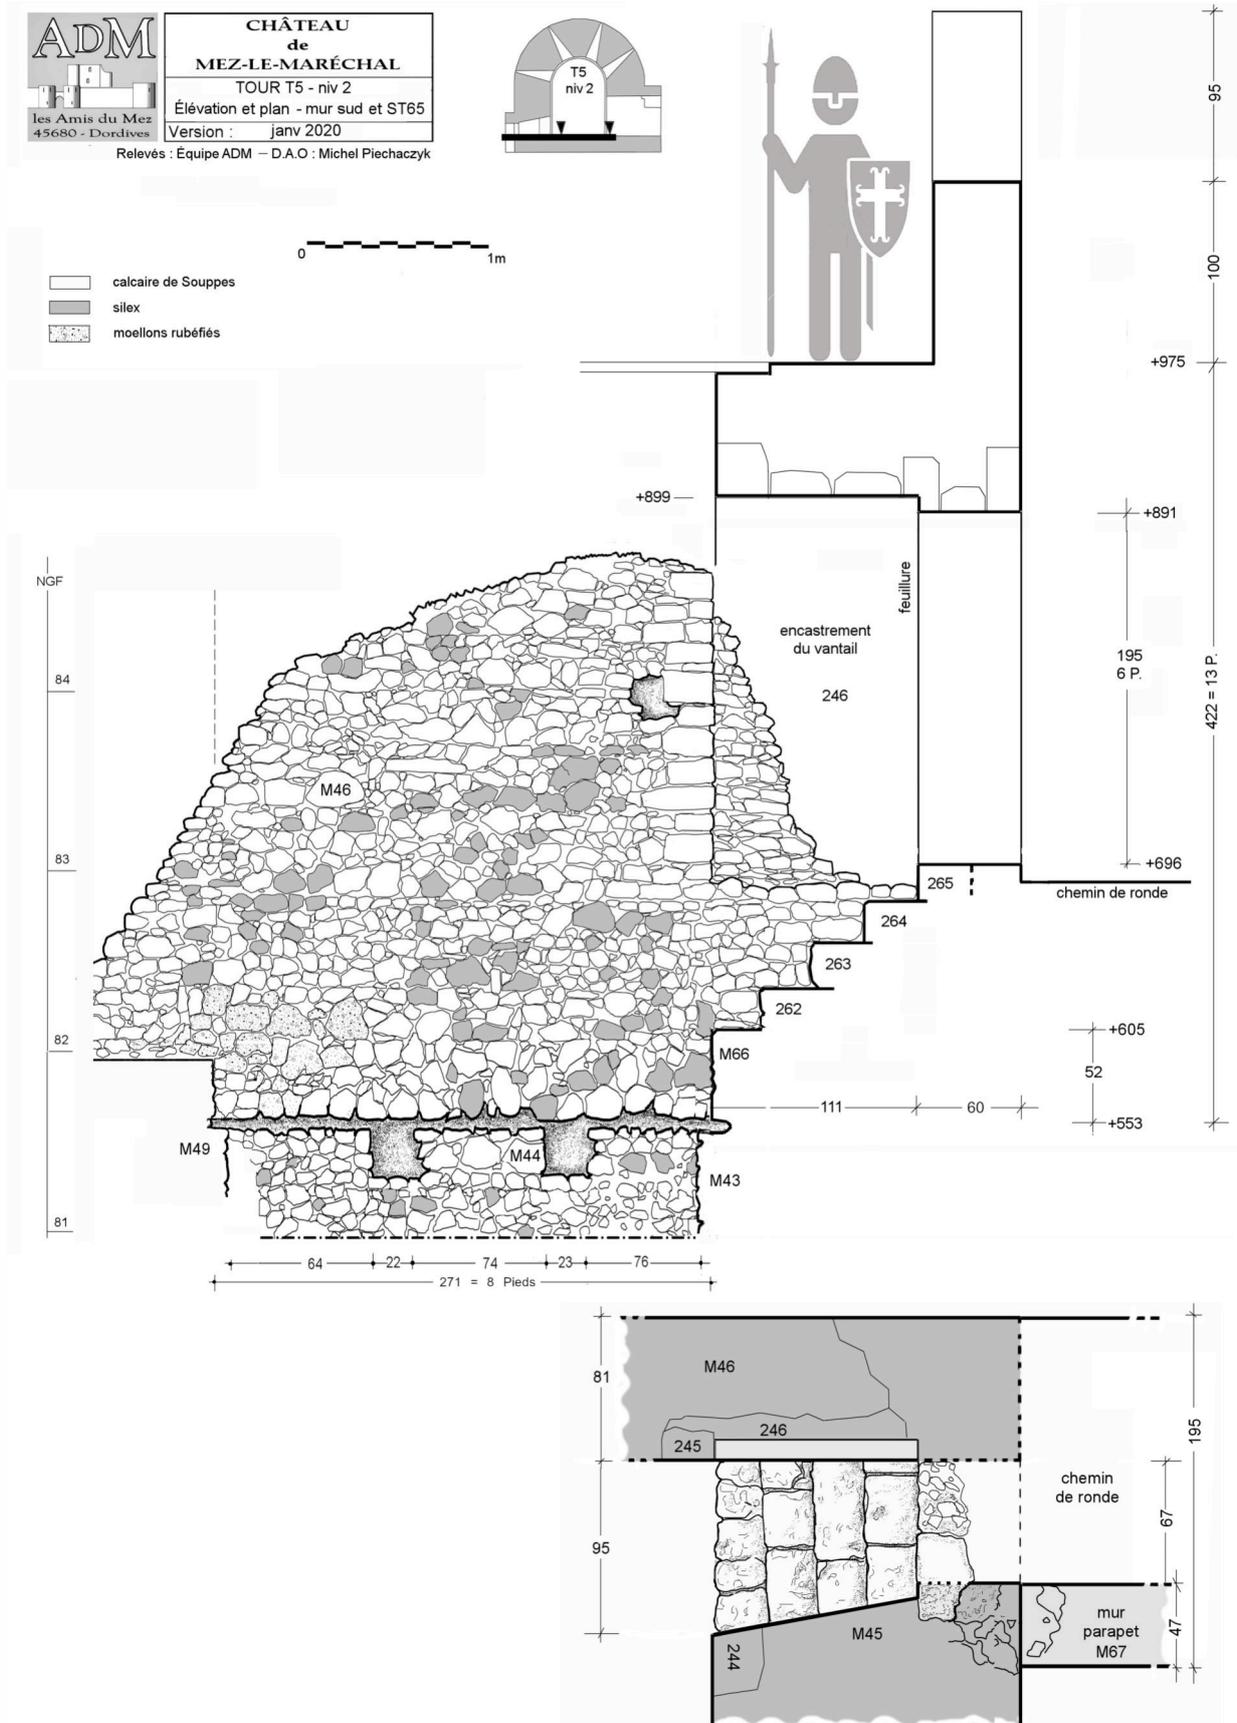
L'escalier ST 65 et sa porte T5-21. Plan et coupe/ Proposition d'élévation du niveau 3 (DAO : Michel Piechaczyk / ADM)
